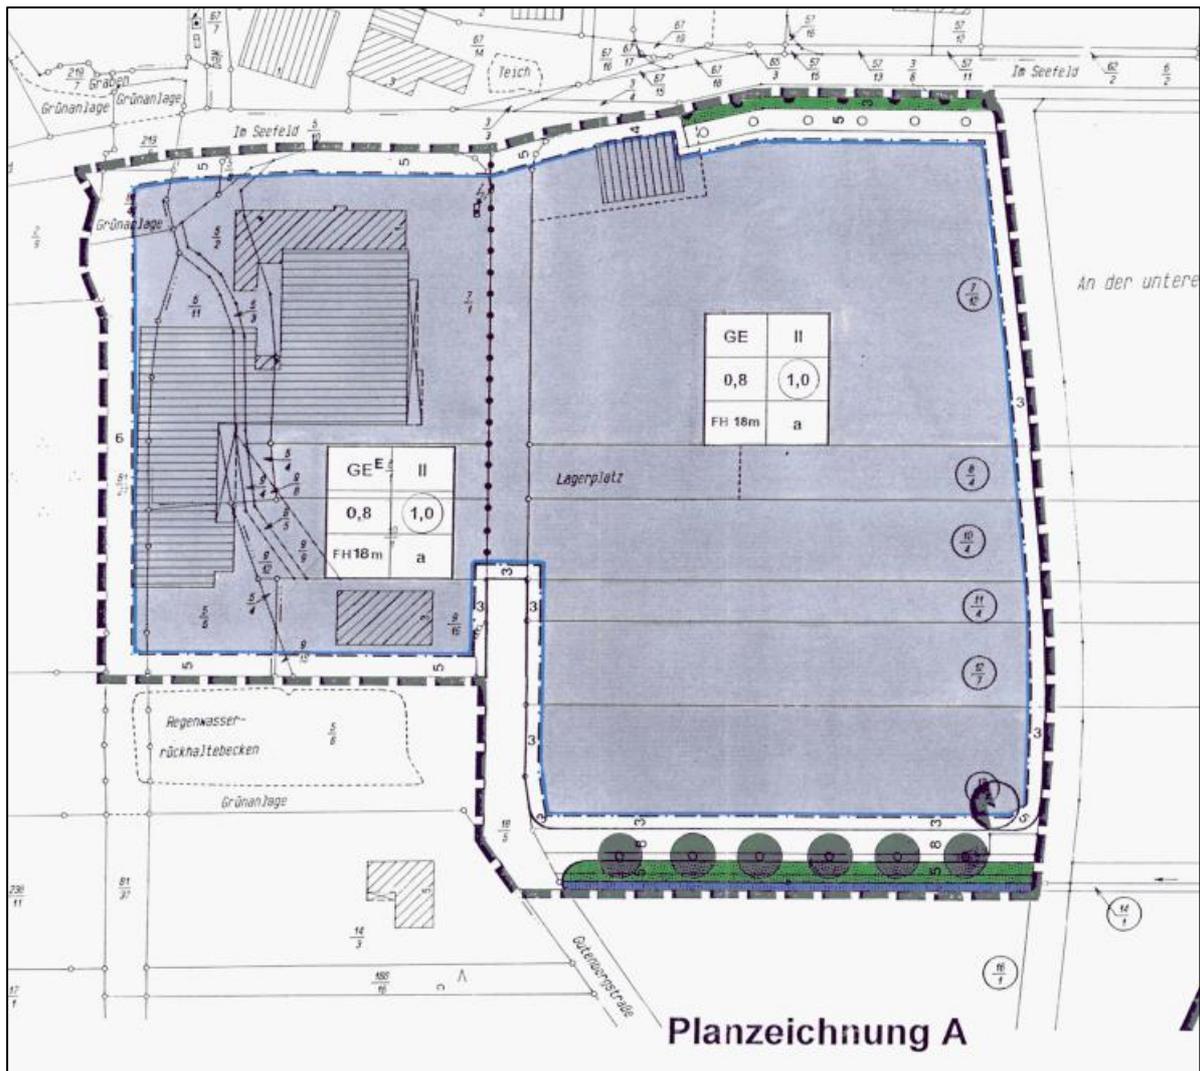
Auszug „Planzeichnung A“ Ursprungsbebauungsplan
